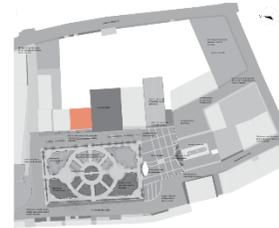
Materiales fachada #7 | Fuente: Elaboración Propia
